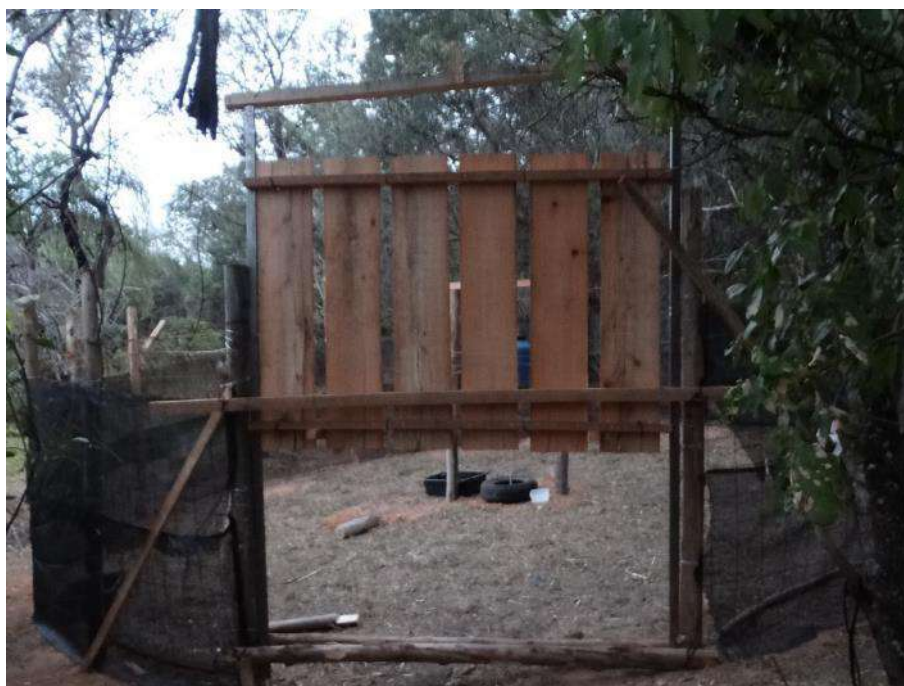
Instalação da porta com fechamento do tipo guilhotina.
